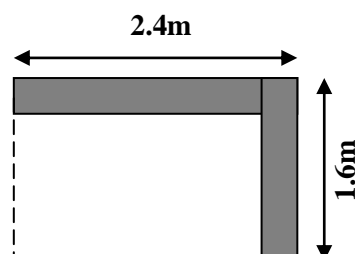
Schéma de la dalle type 01 sur deux appuis
